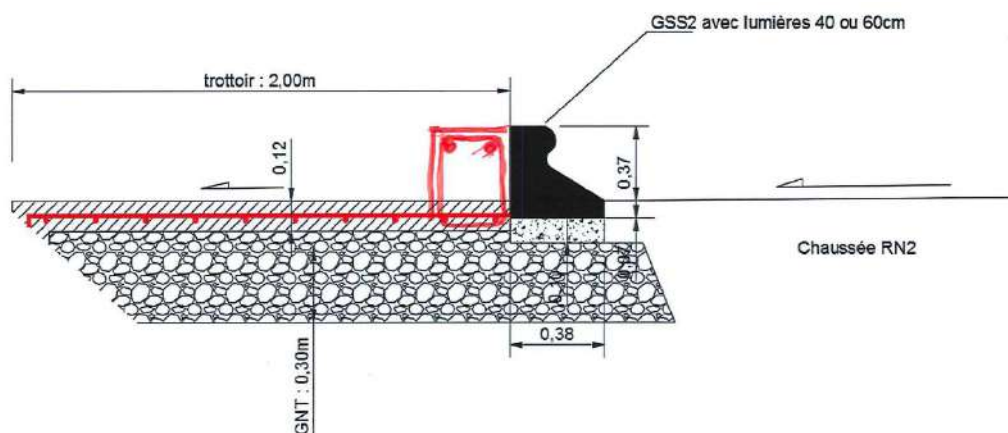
coupe de détail du trottoir au même niveau que la route (« bordure en saillie »)
